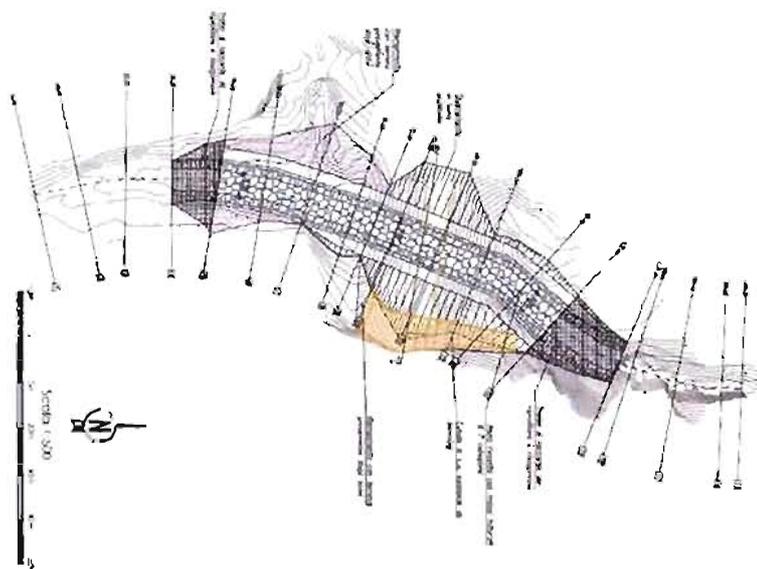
Planimetria sistemazione idraulica sbarramento ST02
